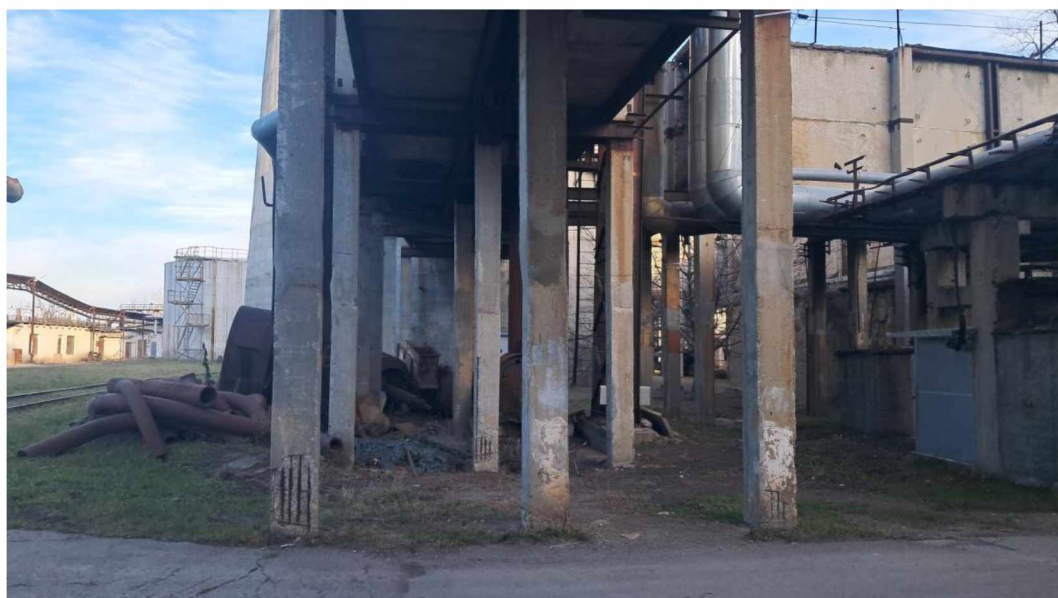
; 18. Vederi generale ale pilonilor canalului.
